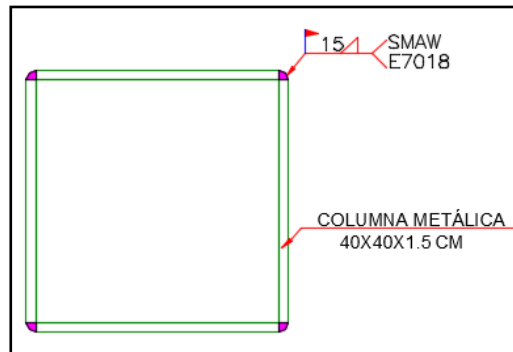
Armado de columna [Carreño J., Cañarte J., 2019]
